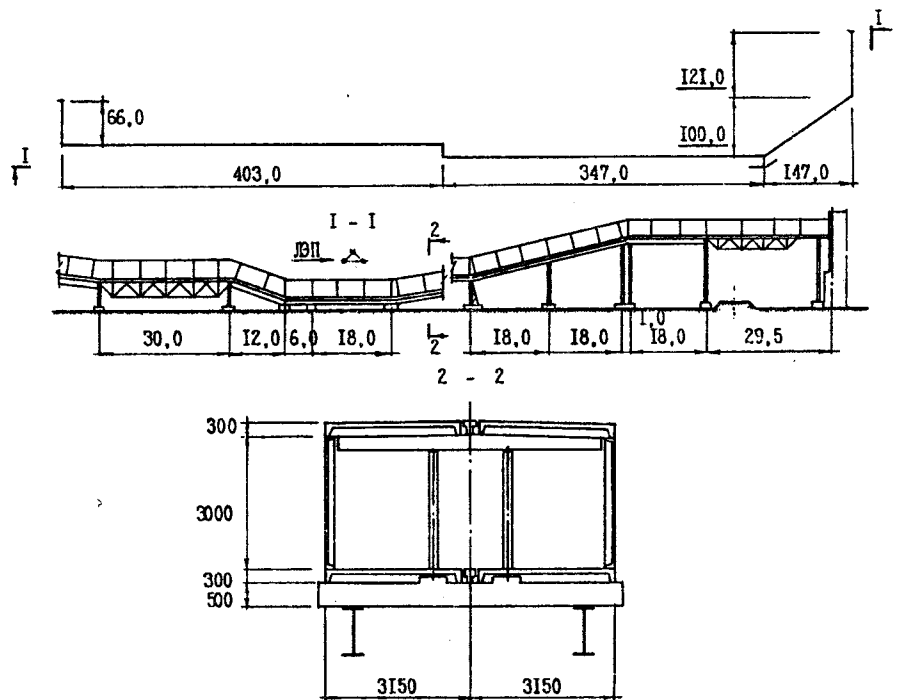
Междоусовые галереи общего назначения с конструкциями стен, покрытия и перекрытия из сборных железобетонных ребристых плит
